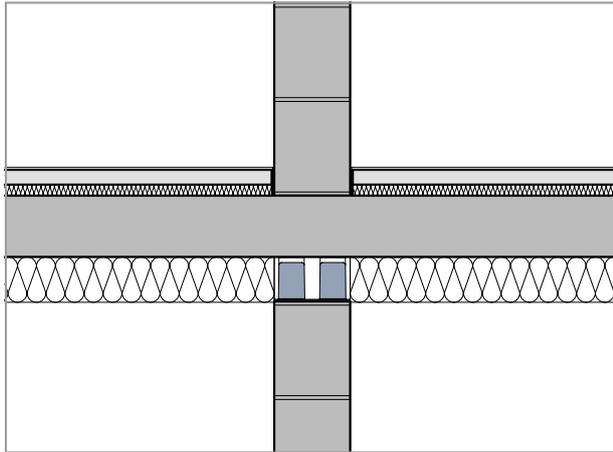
Schöck Sconnex® type M in masonry with internal walls and under-slab insulation
